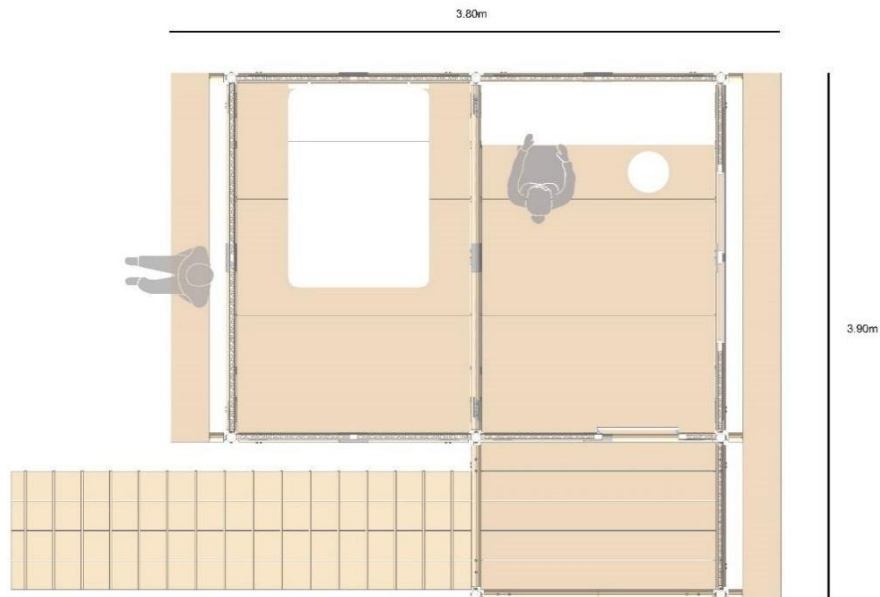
Vista en planta de la distribución del módulo de vivienda sostenible.
